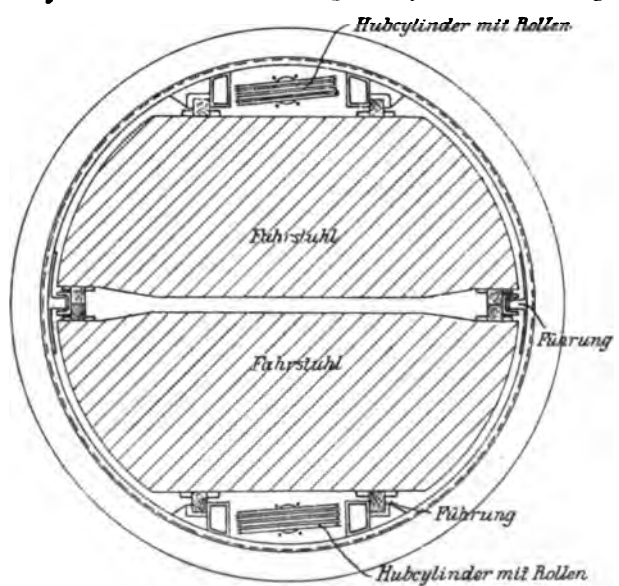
Grundrissanordnung der hydraulischen Aufzüge.
